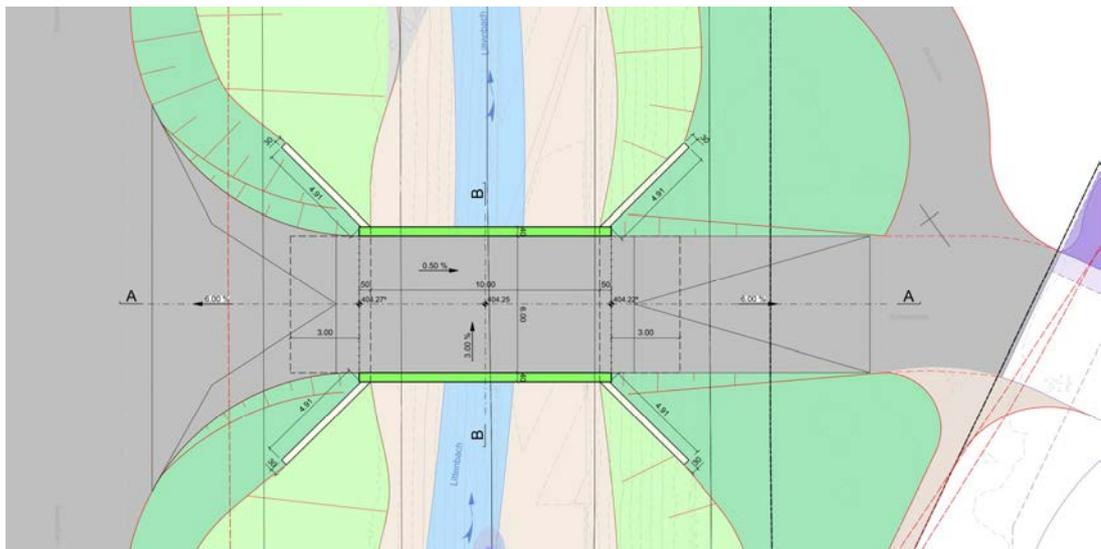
Horizontale Linienführung Brücke Kobelstrasse, Littenbach
